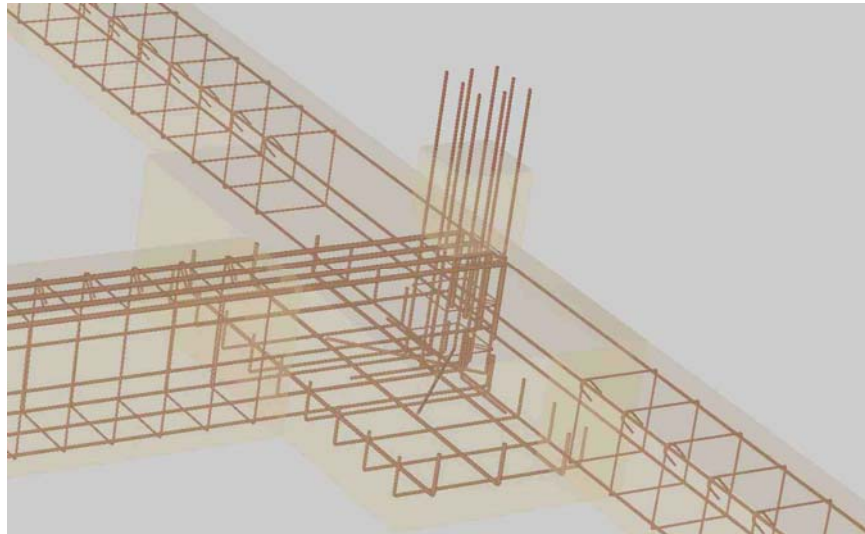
Detalle 3D de Cypecad™ con armado de zapatas y vigas cimentación, efectuado por equipo “Estructura”.2015. (Fte. Elaboración propia)
